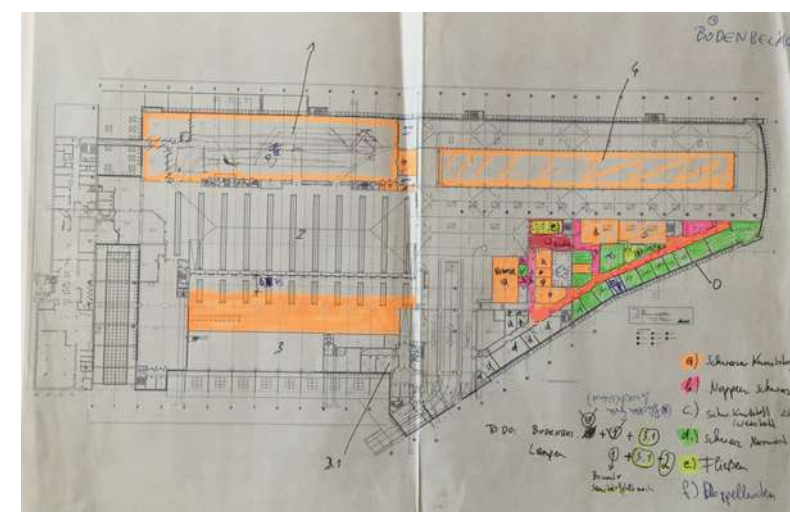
Der Plan des ersten Obergeschosses mit Markierung der Bodenbeläge. © Magdalena Klaus
